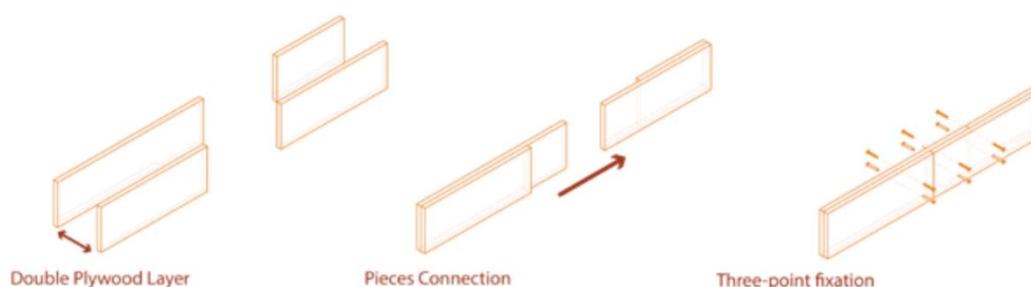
Encaixe proposto na Casa Nordeste. Fonte: Griz; Queiroz; Nome 2017.
